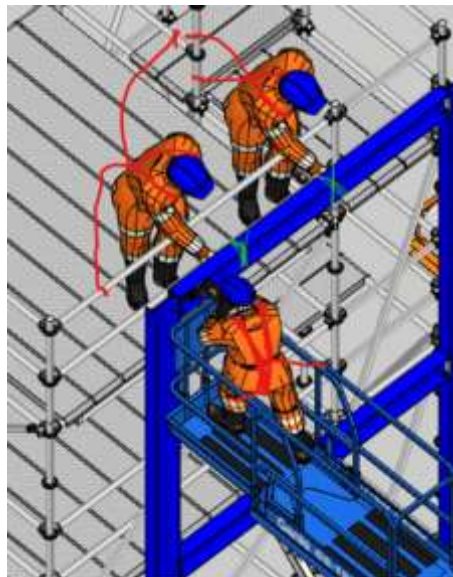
Pemasangan Balok Tengah (B1, B2, B3)
